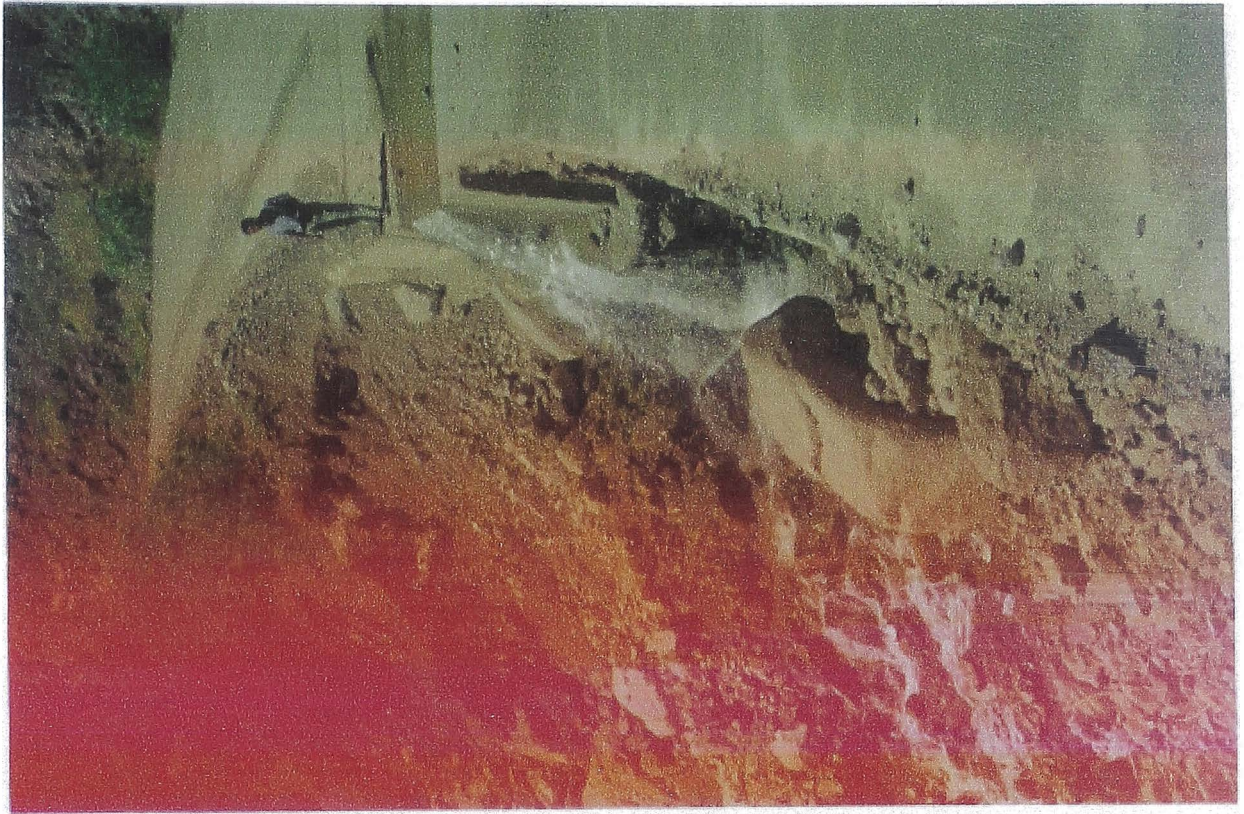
Badén Socavando el talud de terraplén de la vía.
